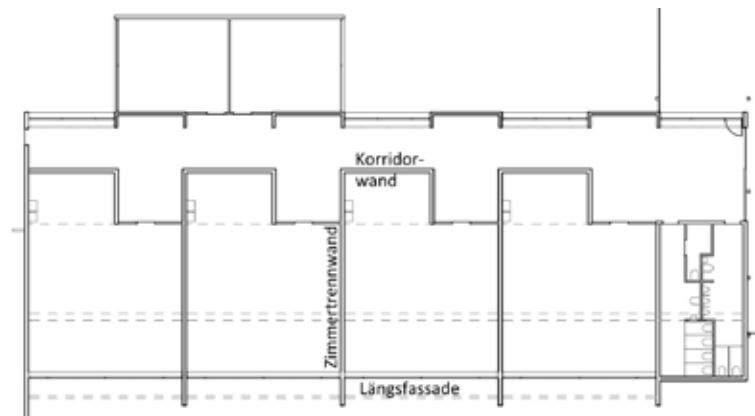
Grundriss Trakt B zur Illustration der Wirkungsrichtung des Erdbebens.
